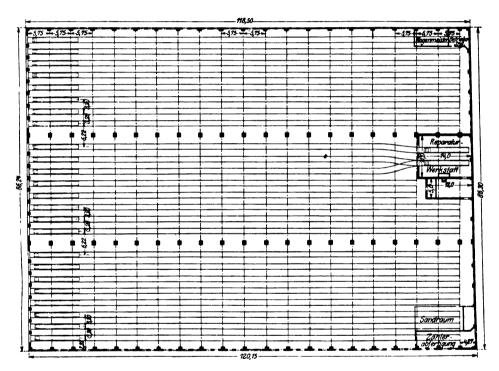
Wagenhallen auf Bahnhof Berliu-Schöneberg. Grundriß.
